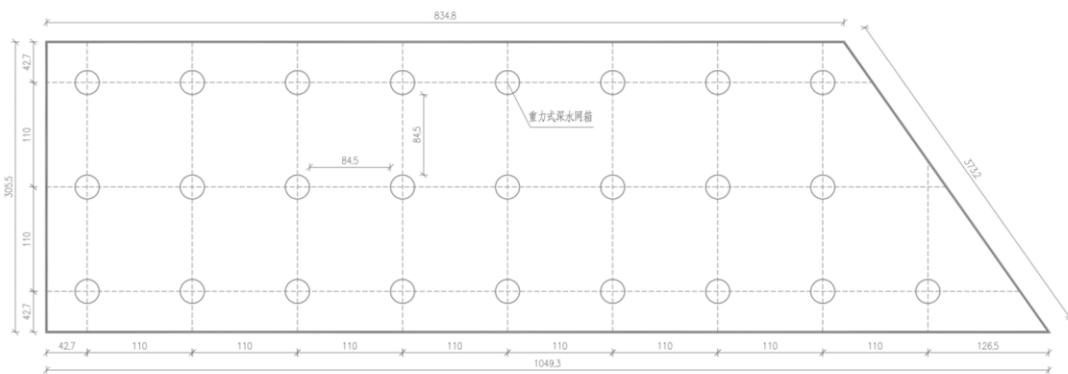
重力式深水网箱养殖区平面布置图
